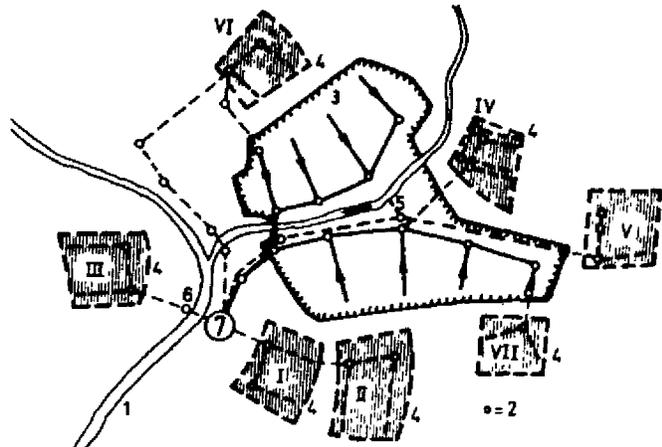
3: Ejemplo de un análisis técnico en la planificación de un sistema de alcantarillado
